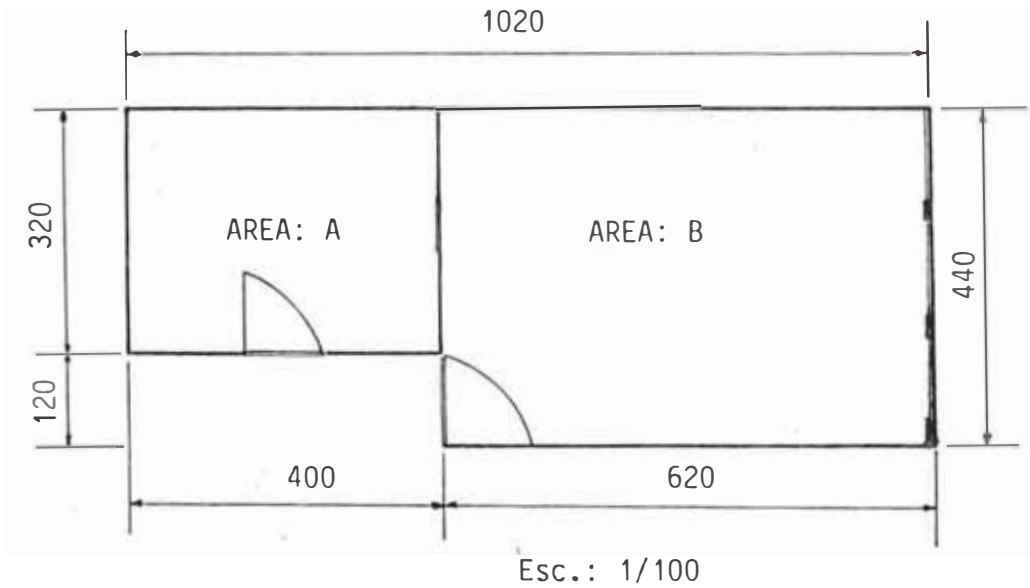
VISTA DE PLANTA DE LA SALA DE MAQUINAS
